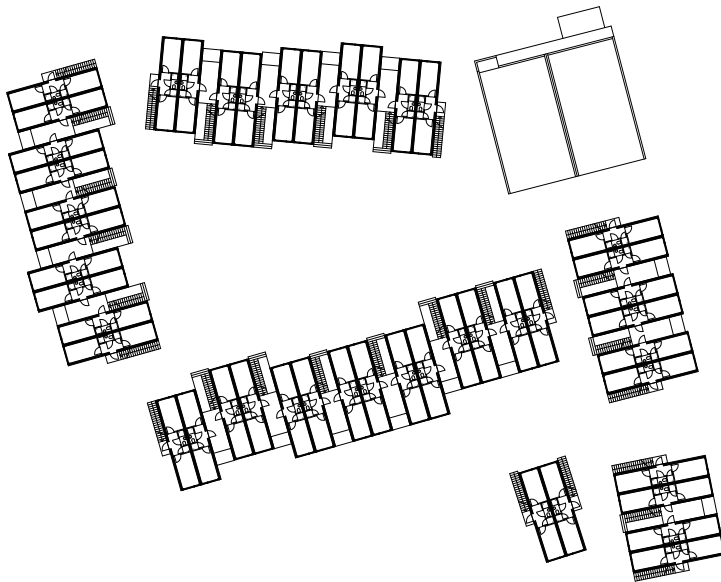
Grundriss Regelgeschoss, M. 1:500 [© BF Vario]
